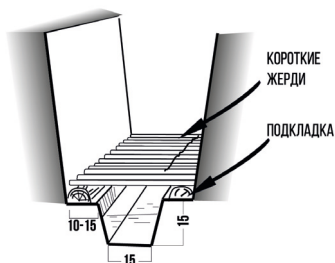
Перекрытая водоотводная канава на дне траншеи
